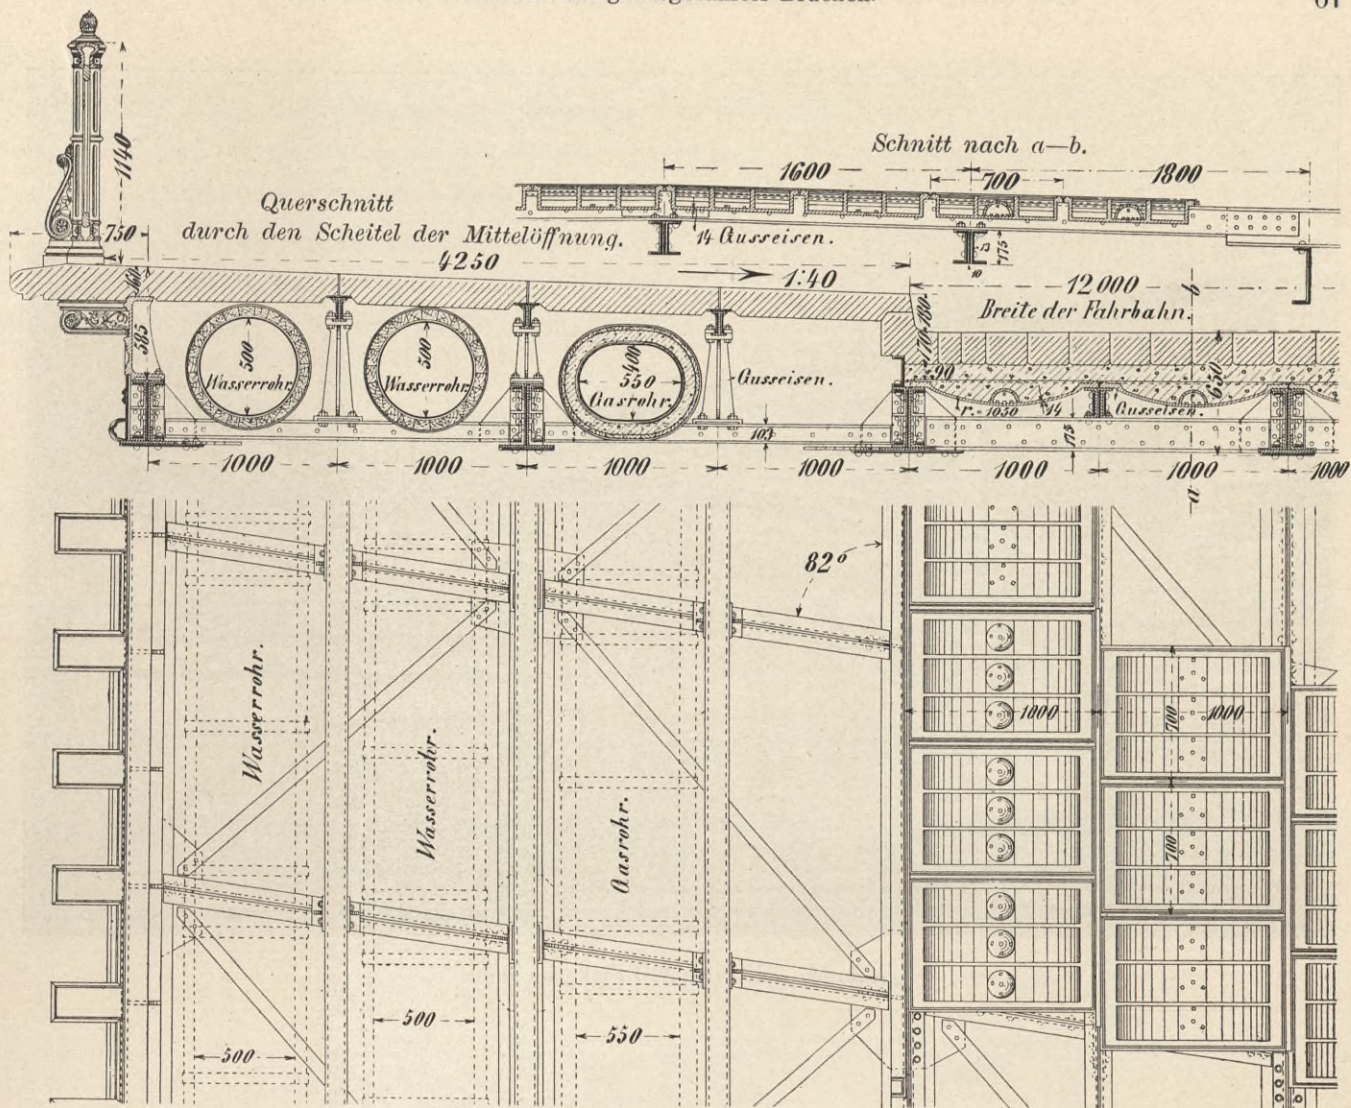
Querschnitt und Grundriss der Michael-Brücke.
